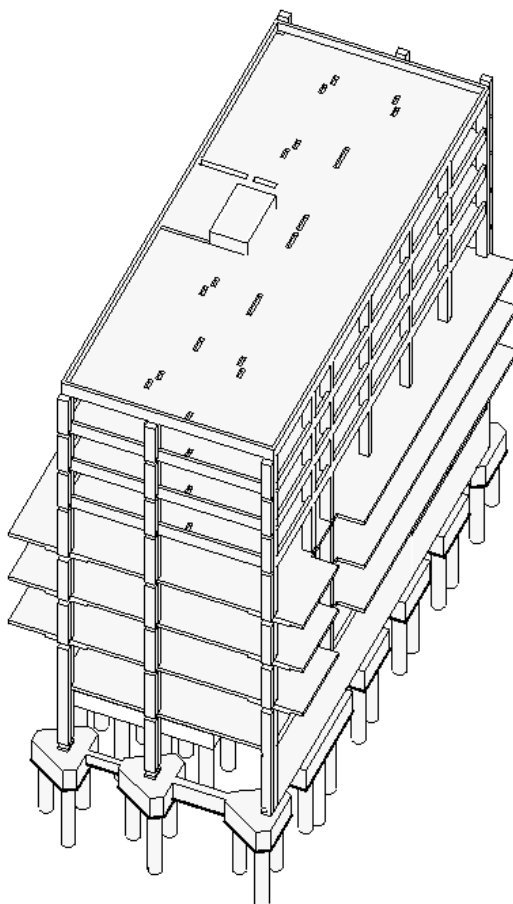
Modelo 3D Da Estrutura (Revit)
